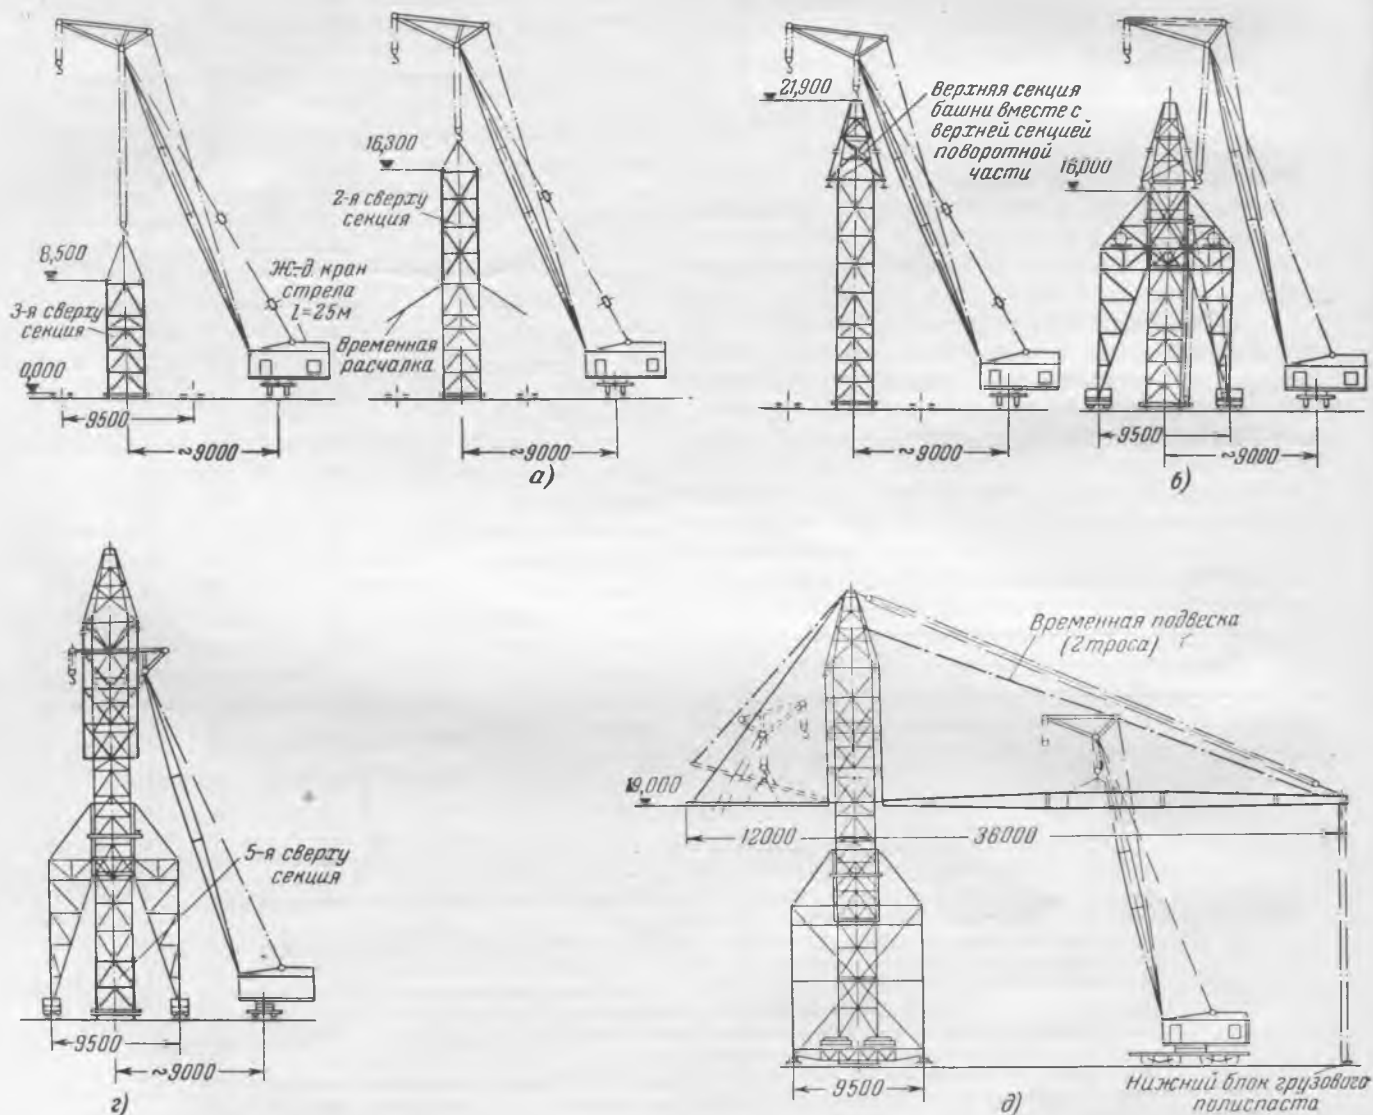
Такелажная схема монтажа верхней части неповоротной башни и портала БК-403 при помощи железнодорожного крана: а — сборка верхней части башни; б — сборка портала с установкой приспособления для одностороннего подъема; в — подъем собранной крана, подрачивание 5-й секции и сборка нижней поворотной части; д — установка решетчатой распорки противовеса и стрелы;
